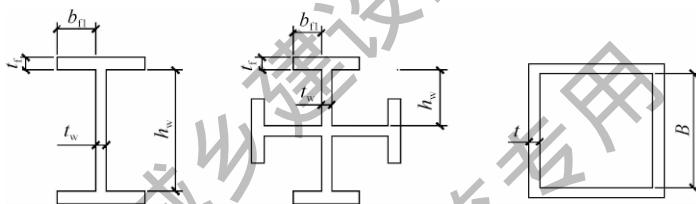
型钢混凝土柱中型钢钢板宽厚比
